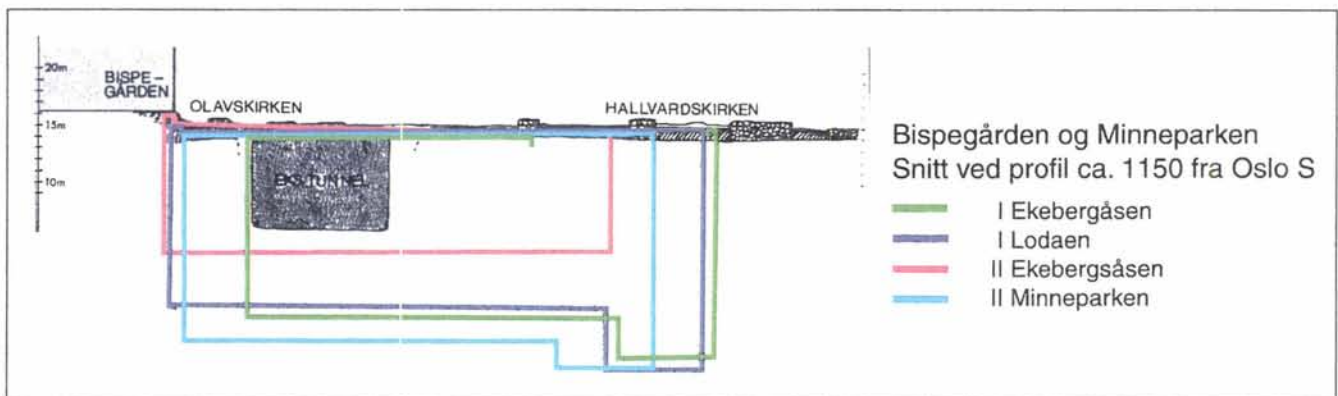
Tenkt snitt gjennom Minneparken fra Bispegården (Olavsklosterets østfløy) til Hallvardskirken med planlagt omfang av kulvert for de forskjellige alternativene. Eksisterende tunnel skravert. Antatte kulturlag markert med svart.
